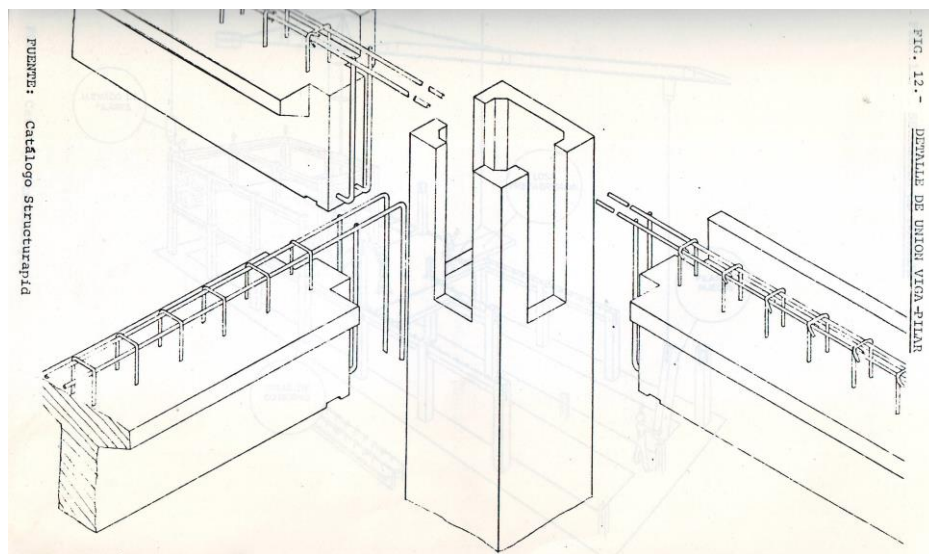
Unión viga-columna en sistema Structurapid Depetris. Fuente: Leónidas Zapata (1983).
